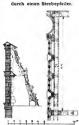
Grundriss und Schnitt. Masstab 1: 300.
